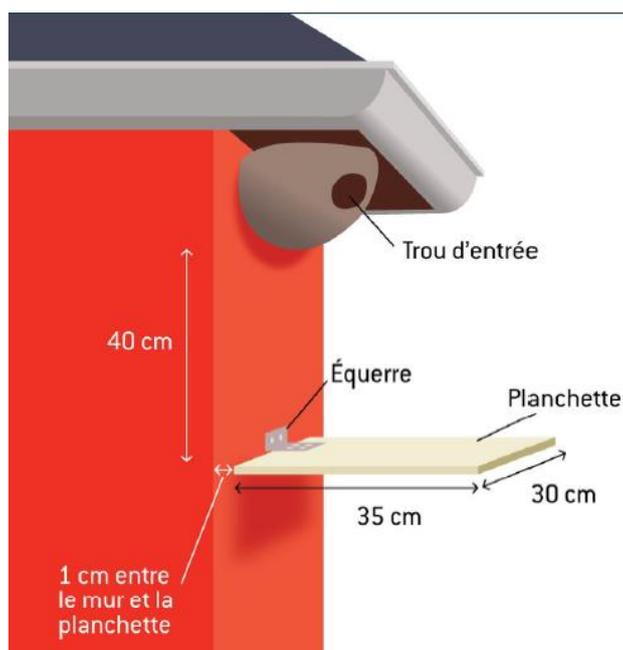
schéma d'installation de planche anti-fiente © Picardie Nature
